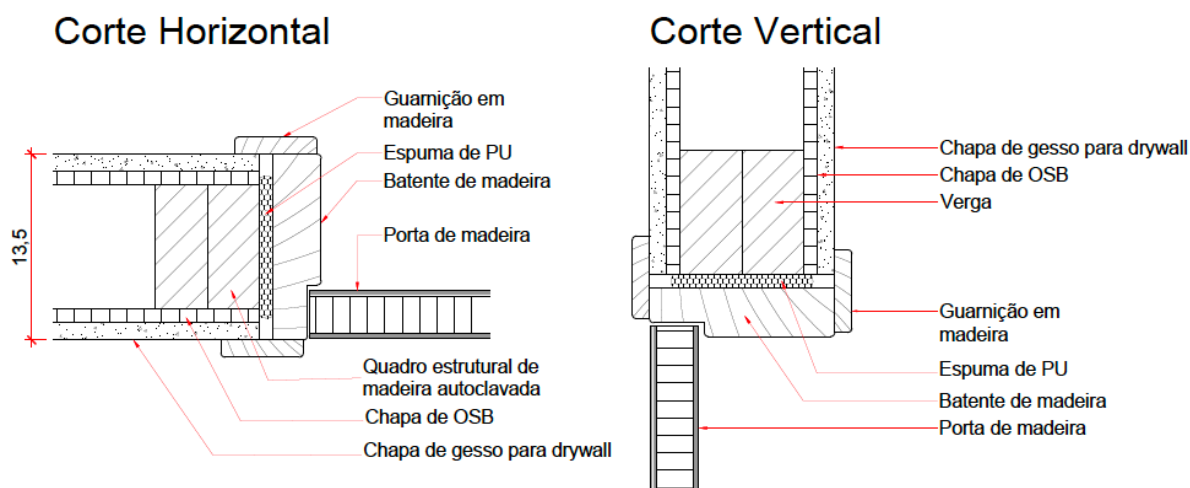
Detalhe em corte da fixação do conjunto de folha porta e batente em madeira na parede interna.
